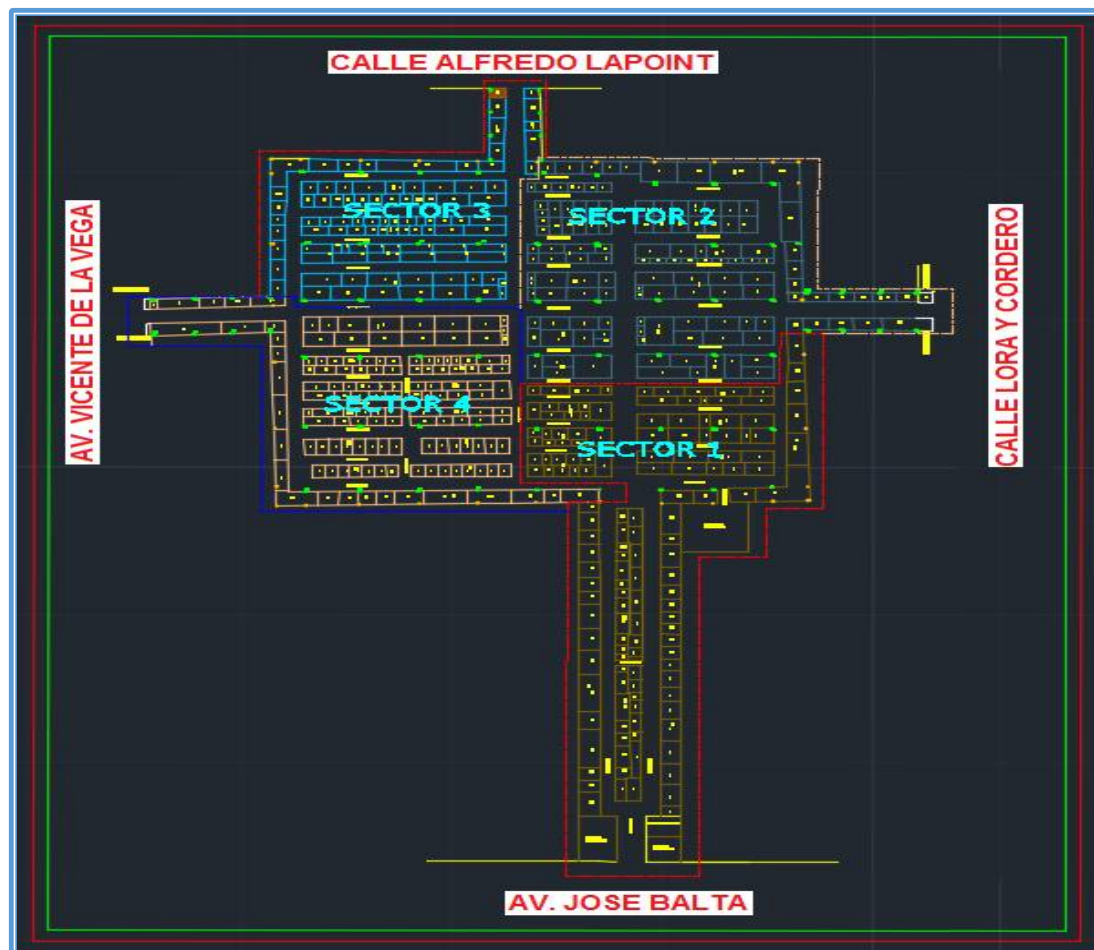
Plano sectorizado en AutoCAD del “Mercado Central de Chiclayo”.
